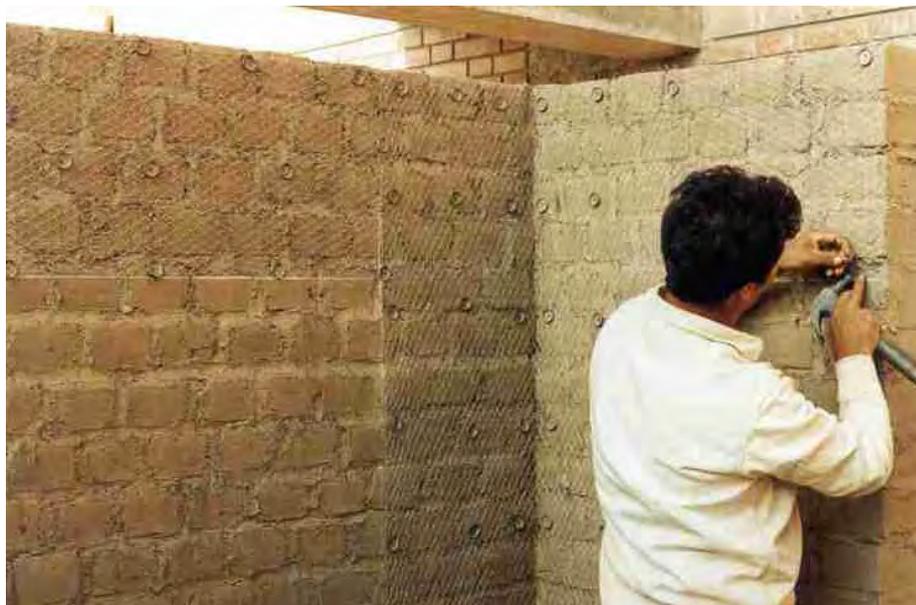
Muro de adobe reforzado con Malla Electro-soldada.
